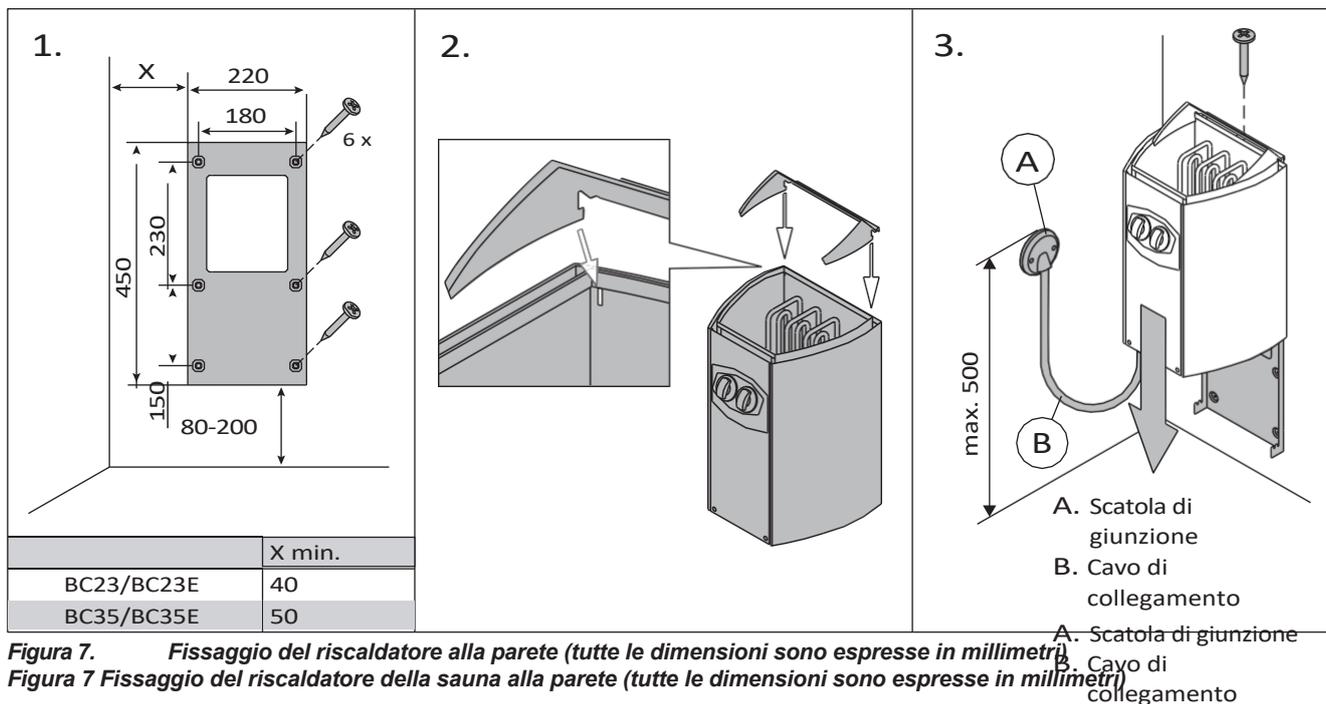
Fissaggio del riscaldatore alla parete (tutte le dimensioni sono espresse in millimetri)
